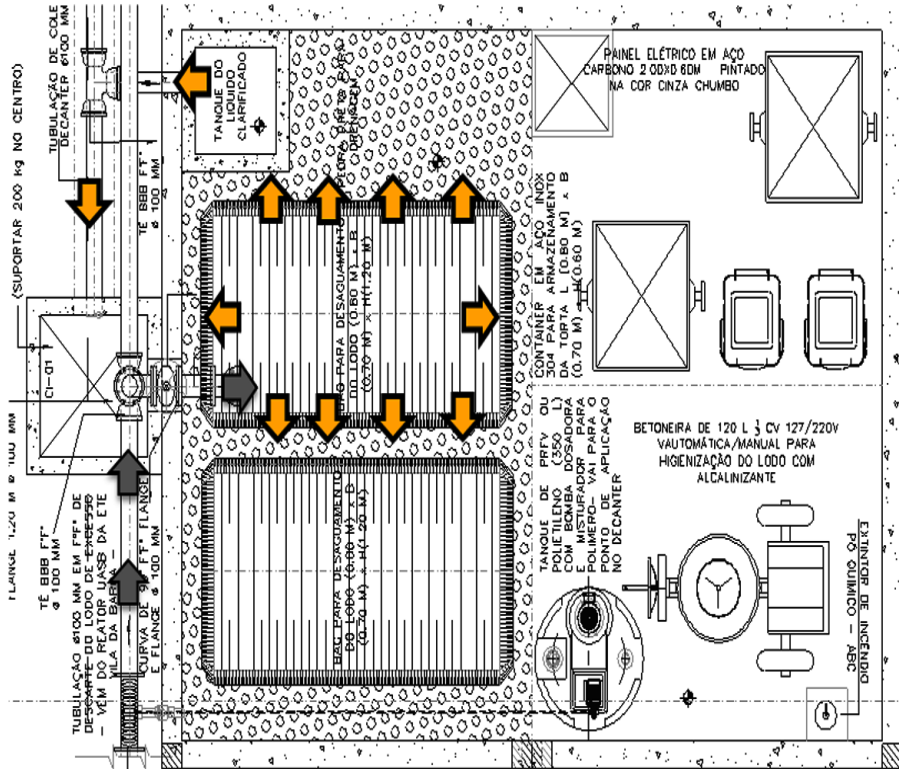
Unidade de desaguamento com bolsa drenante em paralelo, instalação tipo fixa, operação em plano horizontal para atender as etapas de desaguamento e higienização
